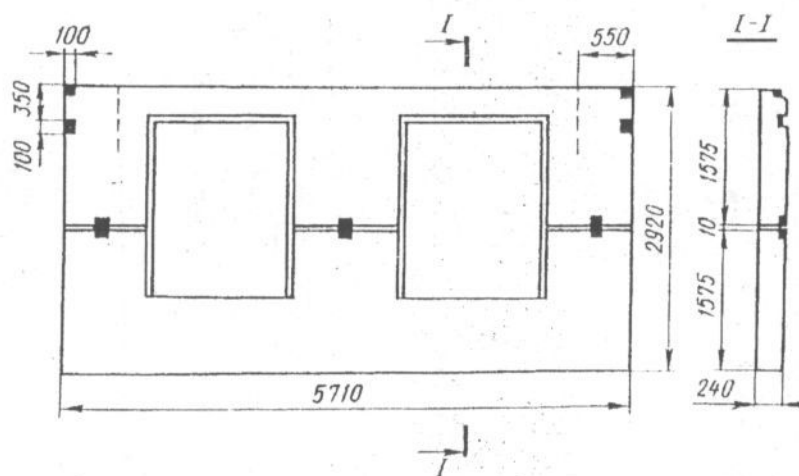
Деталь соединения полупанелей в наружную стеновую панель
